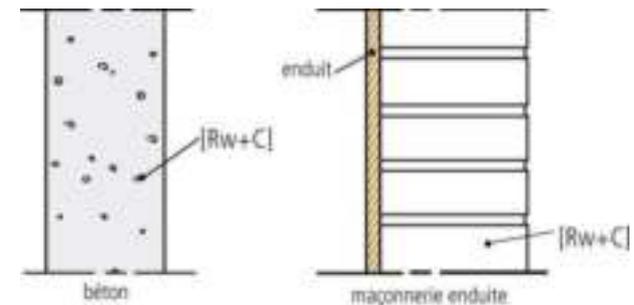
Parois verticales simples en béton ou en maçonnerie enduite, non recouvertes d'un doublage.
